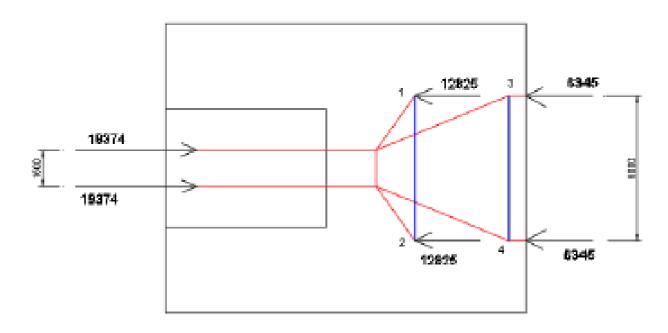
Modelo de bielas y tirantes, vista en planta (Fuente: Propia)
